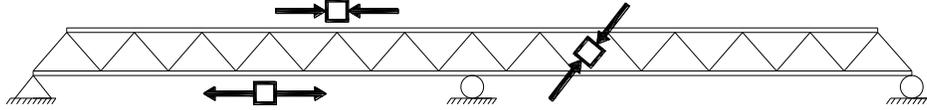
Esfuerzos en un puente tipo viga con armadura.
